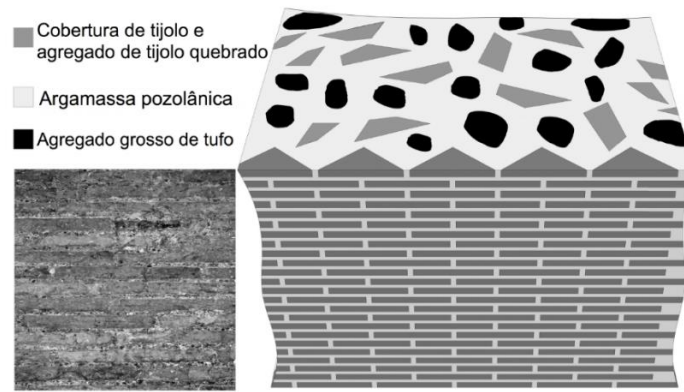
Parede com cobertura de tijolo com desenho esquemático do núcleo de concreto
